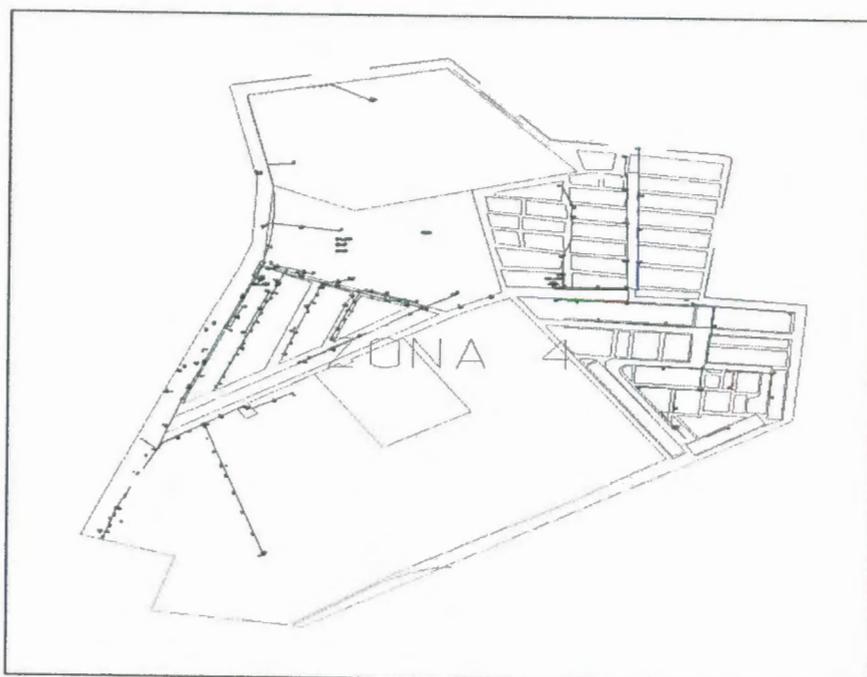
Planimetría zona 4 del sector de la vía a Daule
